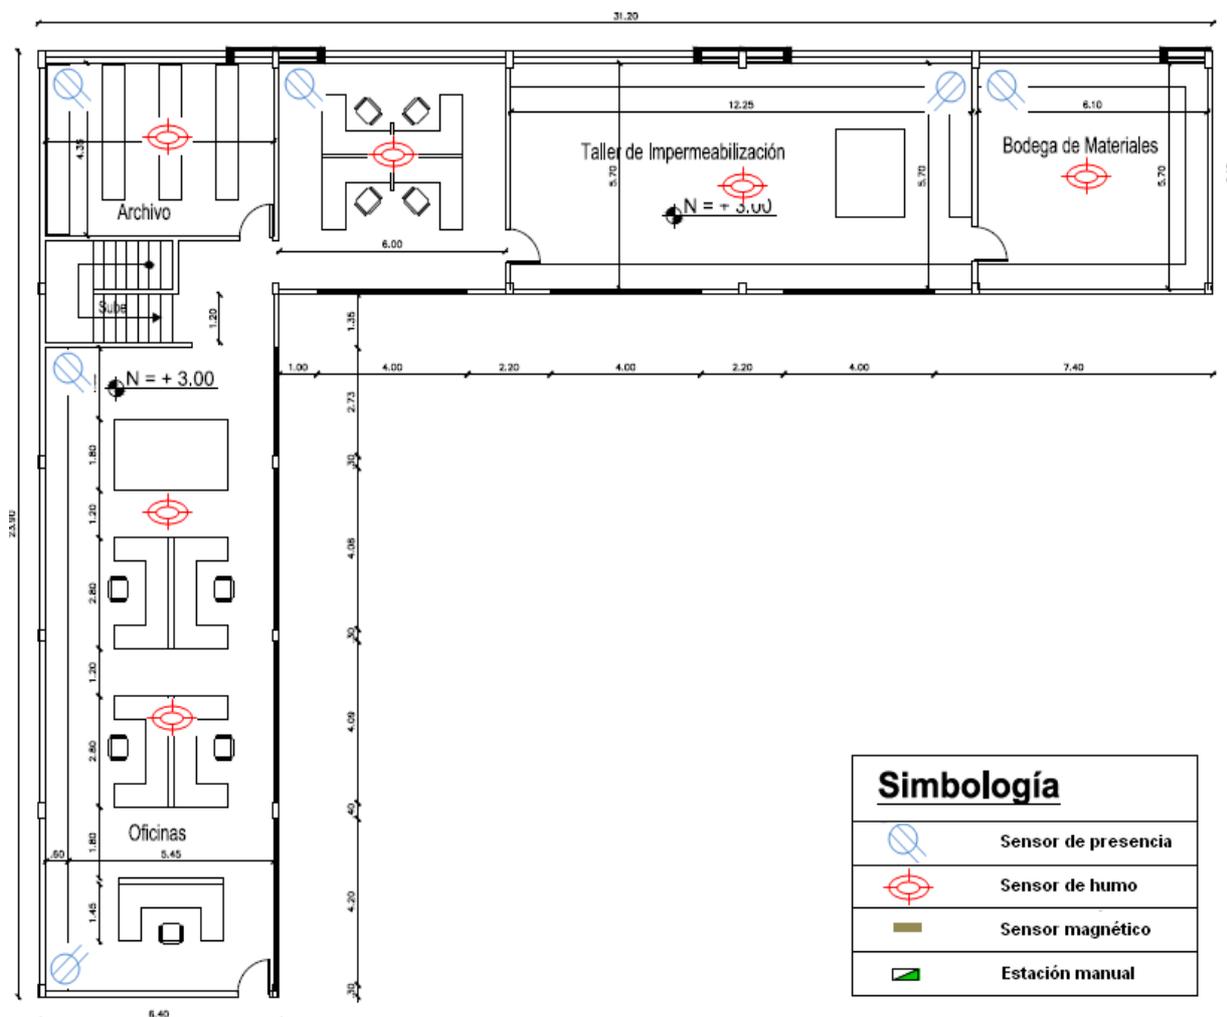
Plano esquemático de las oficinas planta alta, tomado de [1.1].
